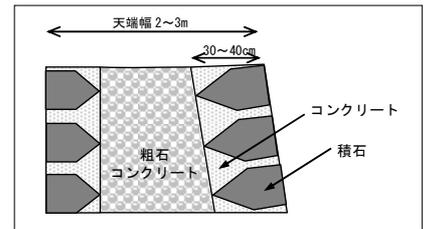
練石積粗石コンクリート製砂防えん堤の模式断面図
